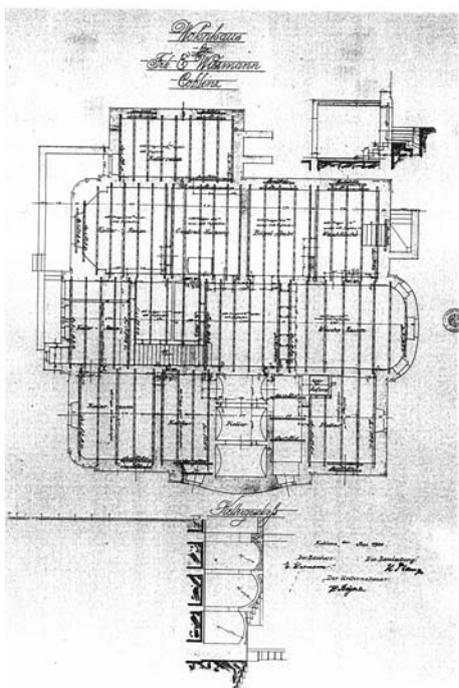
H. Plange, Villa Wiesmann, Grundriss Keller
